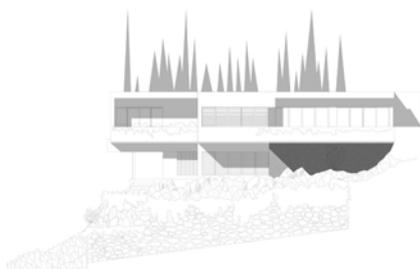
Alzado de la casa Backhaus. Redibujado a partir de alzados originales.
